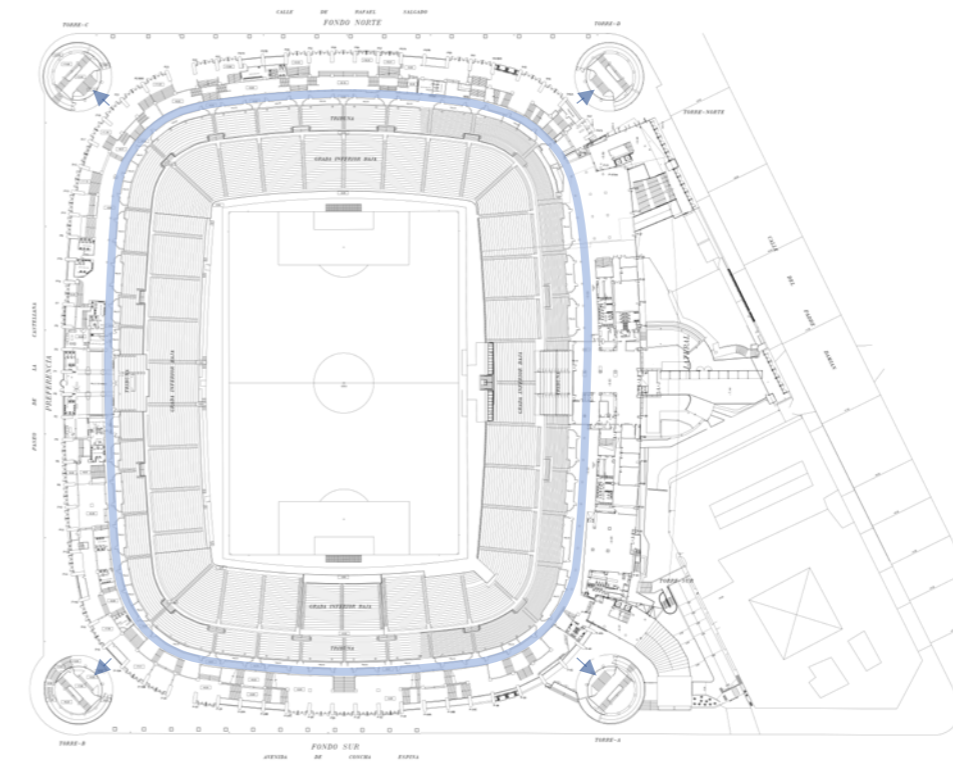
Planta del nivel 1 del estadio tras la reforma de 2002.
